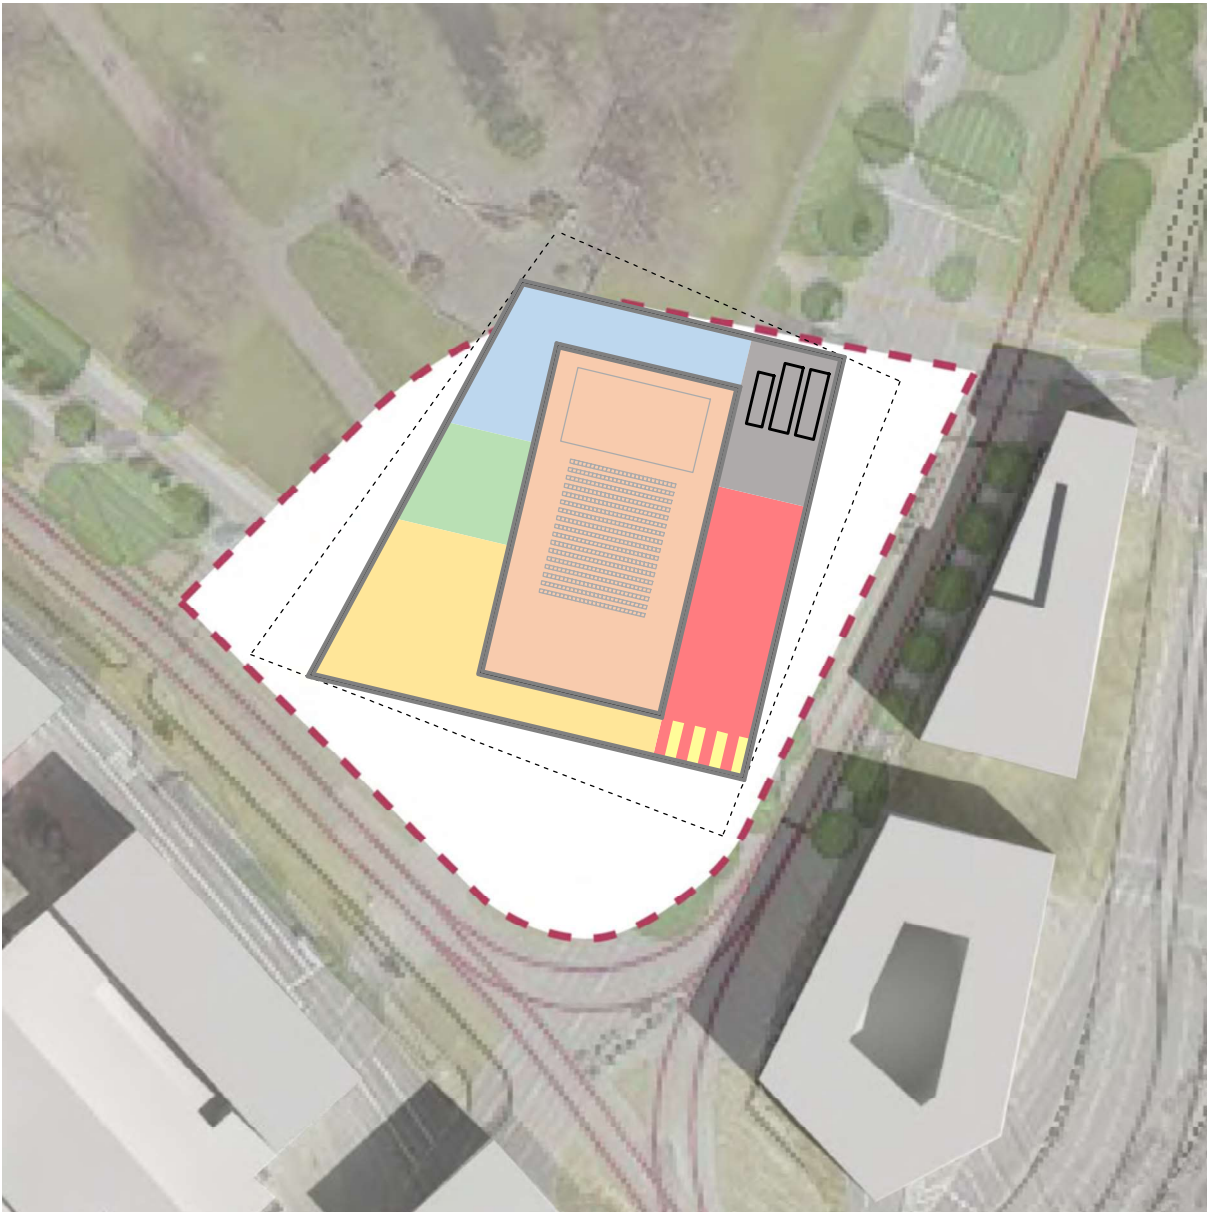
Grundriss EG Bahnhofquartier V1
